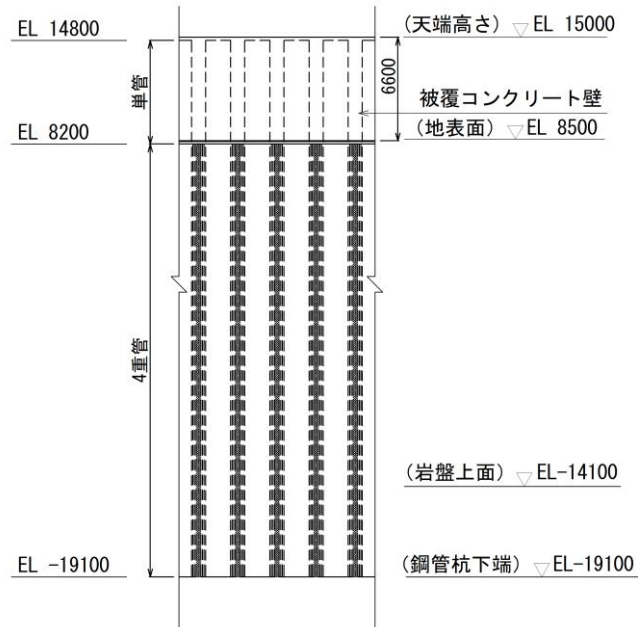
(1) 防波壁（多重鋼管杭式擁壁）の構造図（正面図）
